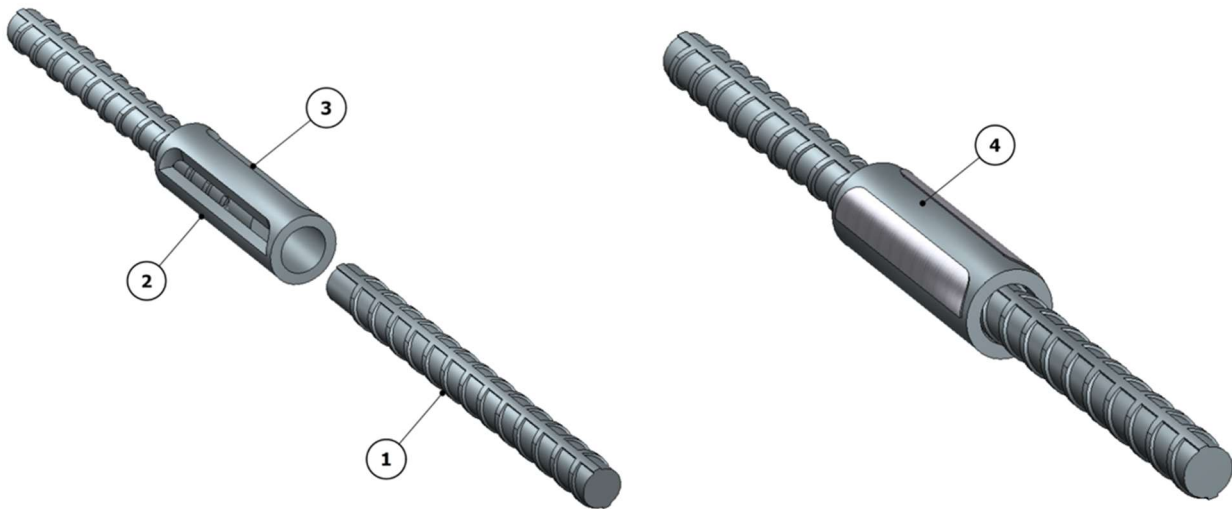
Imagem ilustrativa da luva soldável antes e após a soldagem
